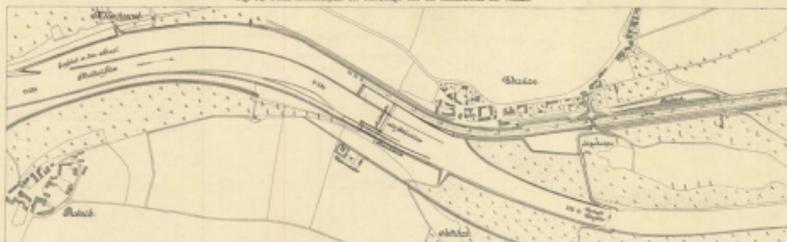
Detail-Situationsplan der Kanalarbrücke bei Lubo.
